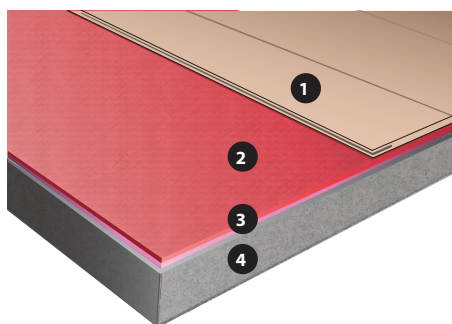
Încălzire în pardoseală cu DEVIDry™ pe planșeu existent din beton
